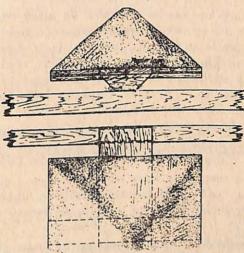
Plateforme Dortmund basculant autour d'une planche centrale.
